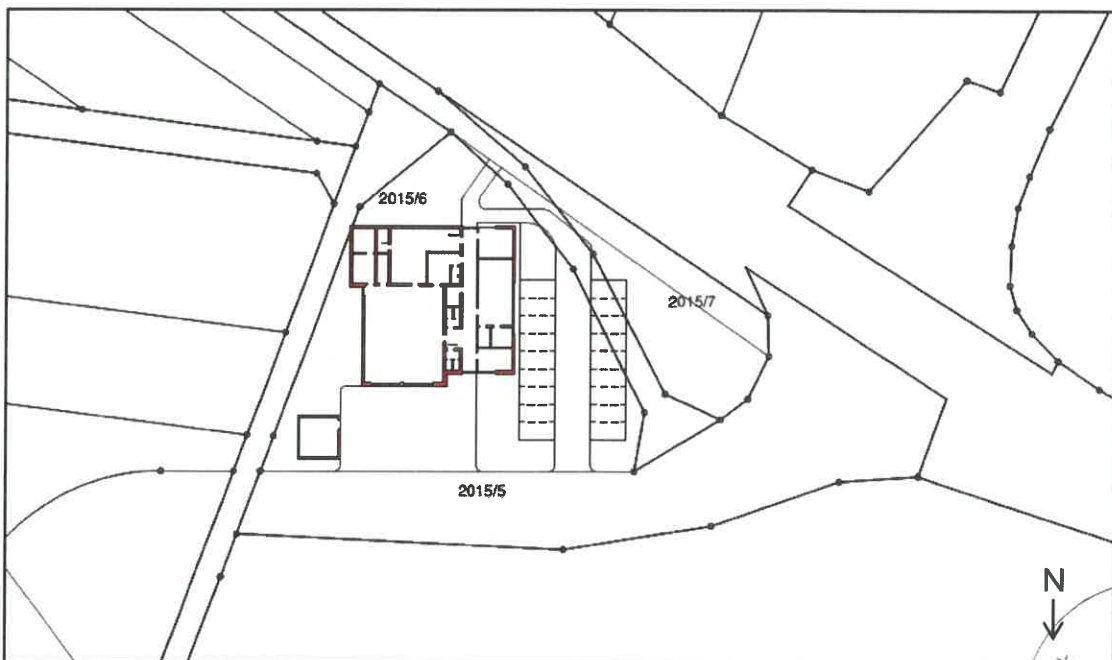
Lageplan des Feuerwehrneubaus vom 19.12.2017, unmaßstäblich
